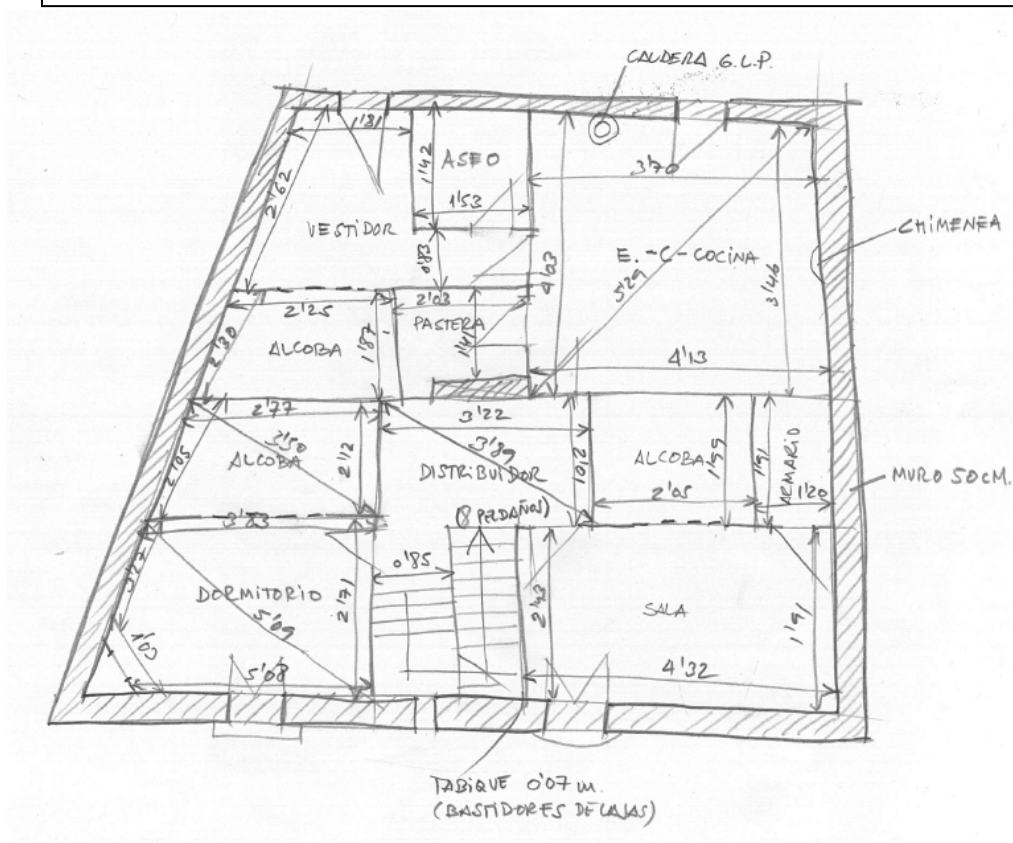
Croquis de la la planta 1ª del inmueble.
